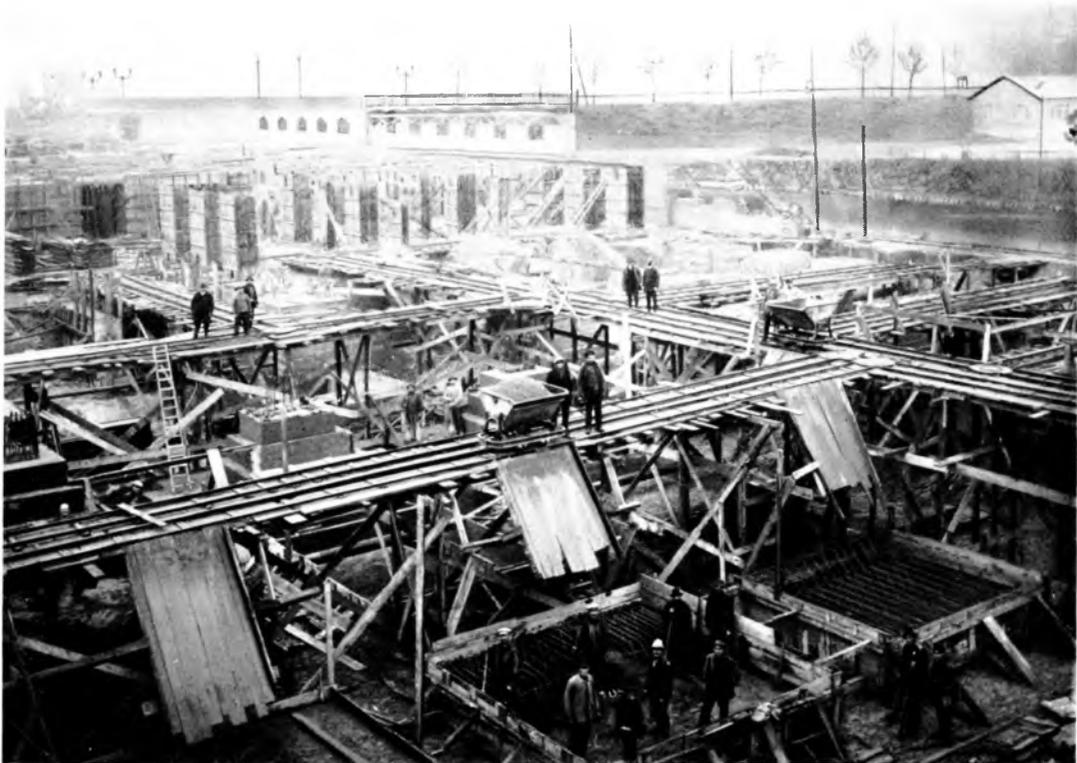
Betonieren der Fundamente des Bauteils VII. Der Beton wird auf den Schüttbrücken in Kippwagen angefahren, durch Rutschen in die Fundamente eingebracht und dort verarbeitet
